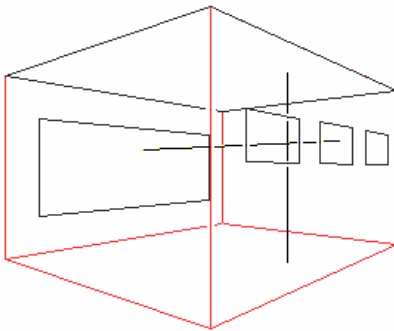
Modellraum mit drei elektrischen Heizflächen gegenüber dem Fenster
